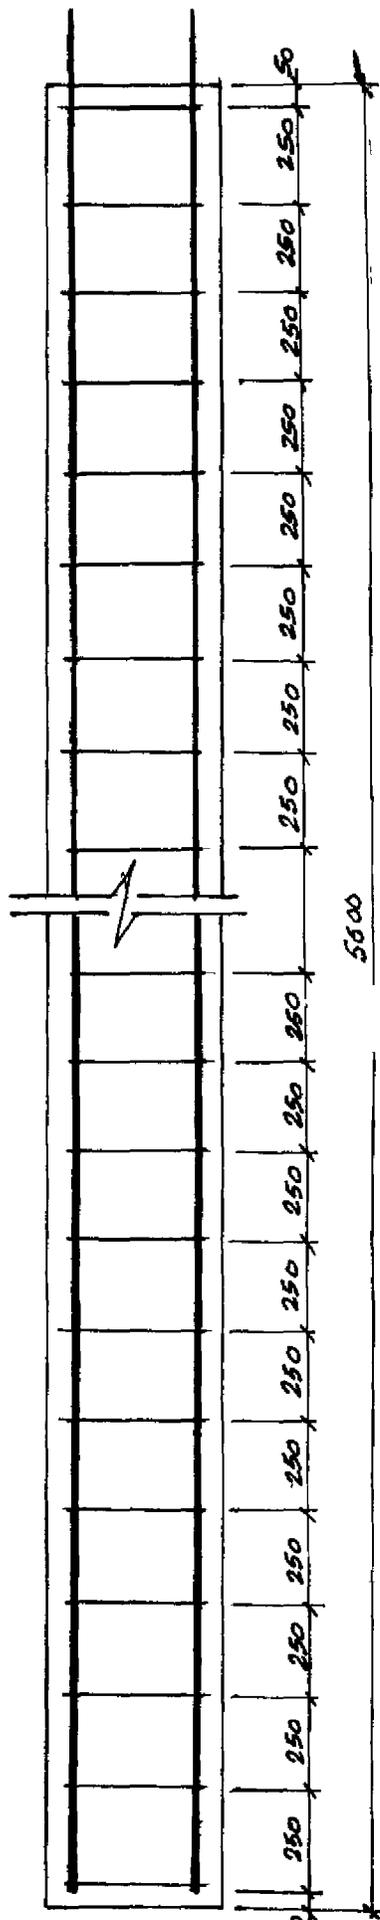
DETALLADO ACTUAL DE LOS ACEROS DE LAS COLUMNAS DEL SISTEMA GIRRO
